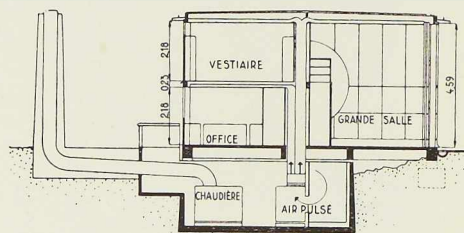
Coupe transversale. On note la disposition particulière de la cheminée.
